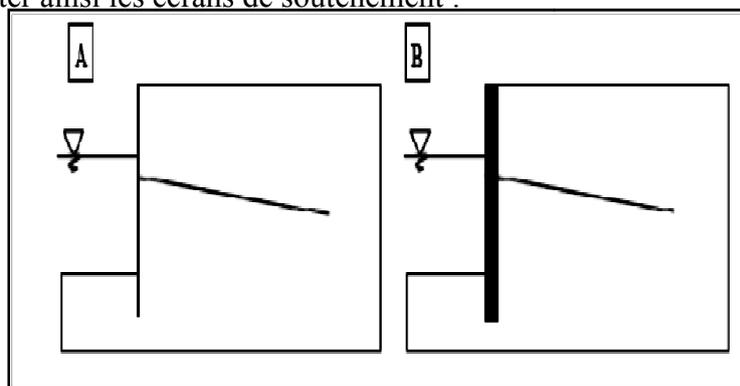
Quais en rideaux de palplanches (A) et parois moulées (B) [3]
